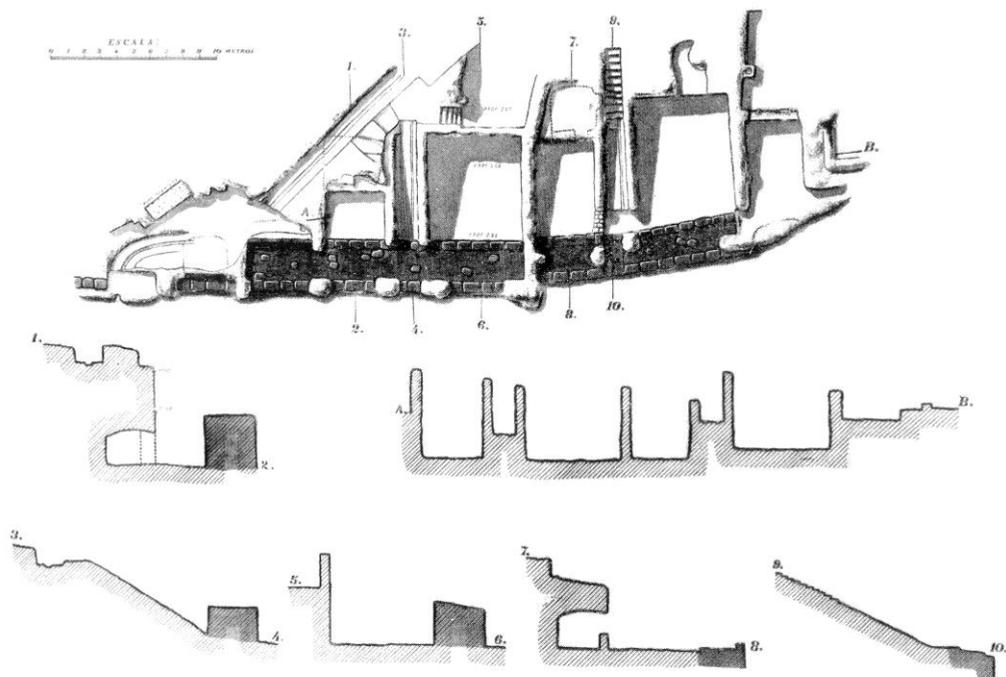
Planta y secciones del Conjunto rupestre del Sur/Casas de Taracena, amortizadas por la muralla bajoimperial (Taracena, 1935).
